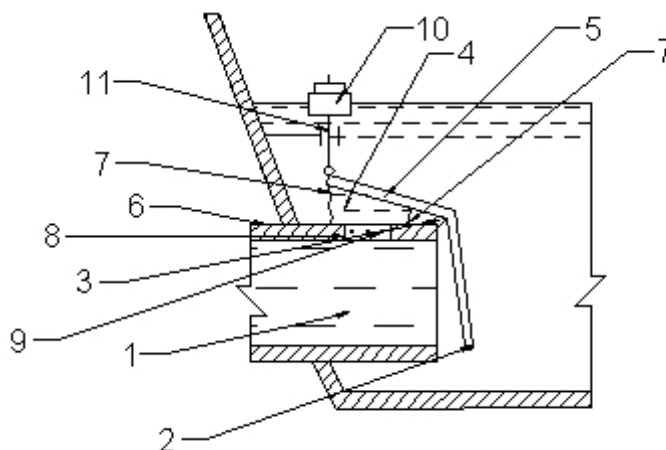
Щитовой авторегулятор с камерой противодавления: 1 – водовыпускная труба; 2 – щитовой затвор; 3 – ось вращения; 4 – камера противодавления; 5 – щит; 6 – основание; 7 – гибкая оболочка; 8 – отверстие; 9 – решетка; 10 – поплавок; 11 – штанга
